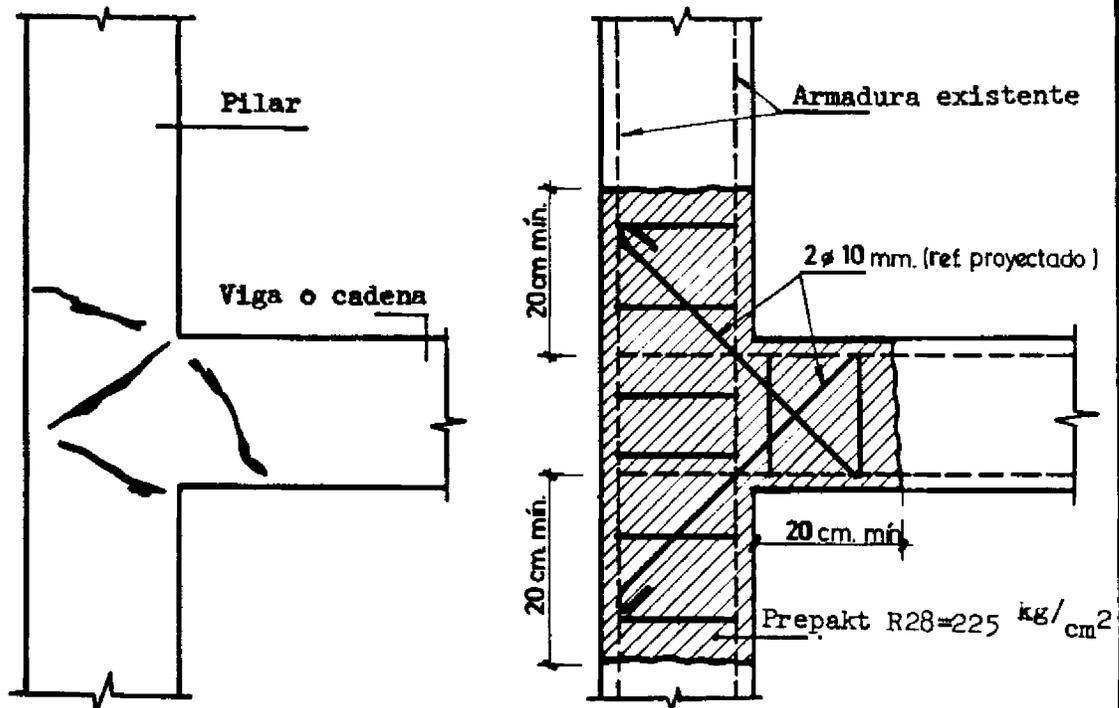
Caso P-2. REPARACION DE UN ENCUESTRO DE PILAR Y VIGA (o cadena)
